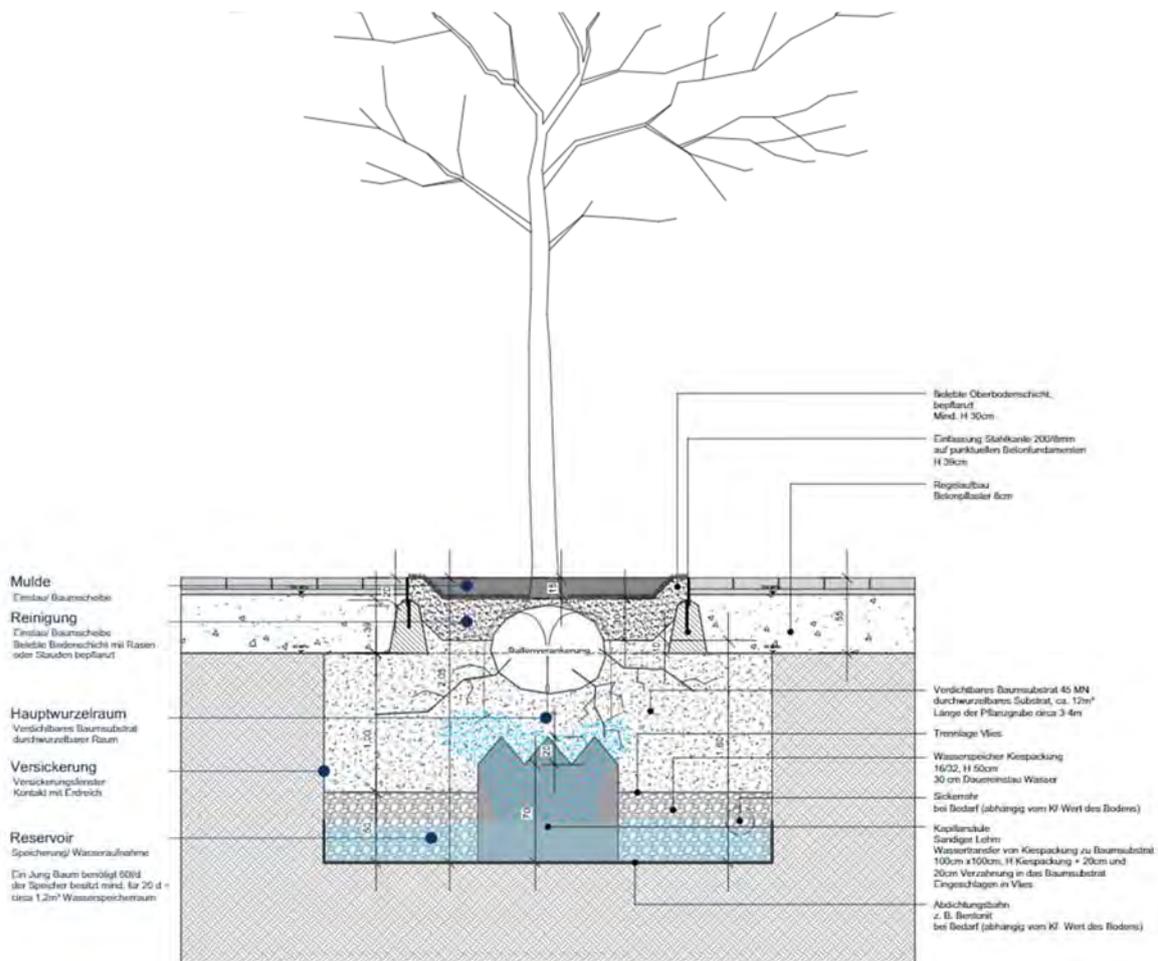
B mögliche Konstruktion einer Baumrigole
